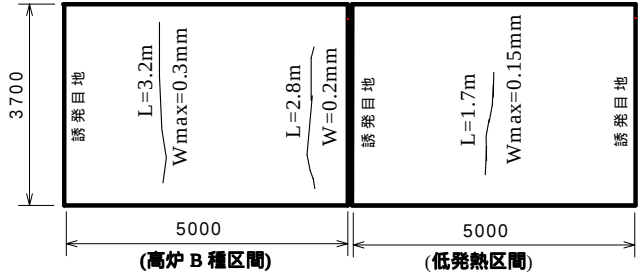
ひび割れ発生図(材齢 13 週)
